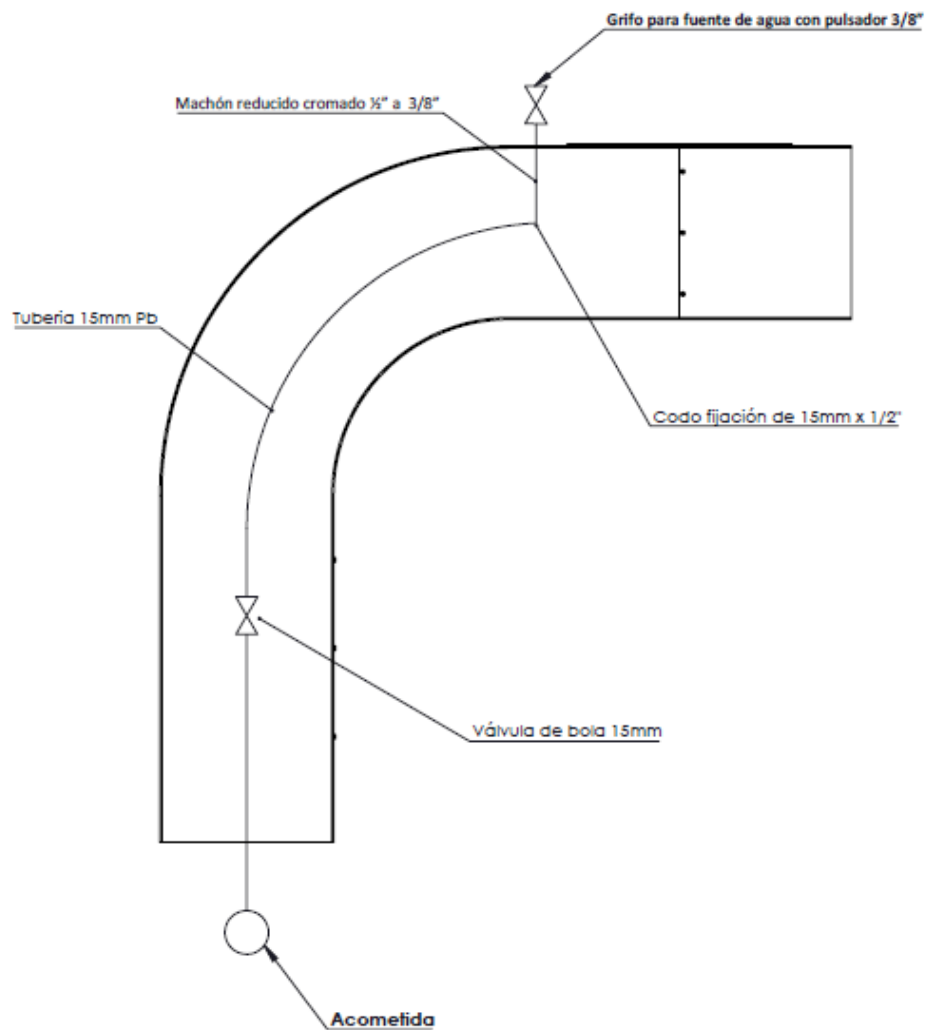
Diseño de fontanería de la Fuente de exterior. Unidades: mm Fuente: Elaboración propia
